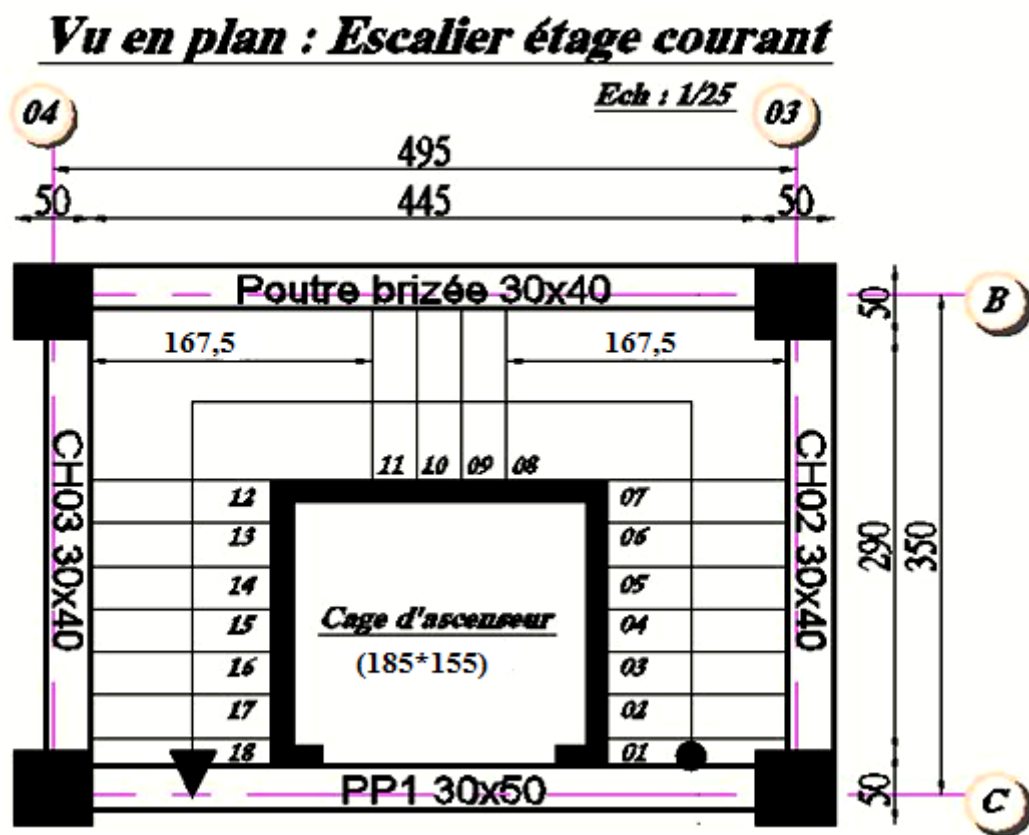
N°03 : Vue en plan de la cage d'escalier type 01 .
